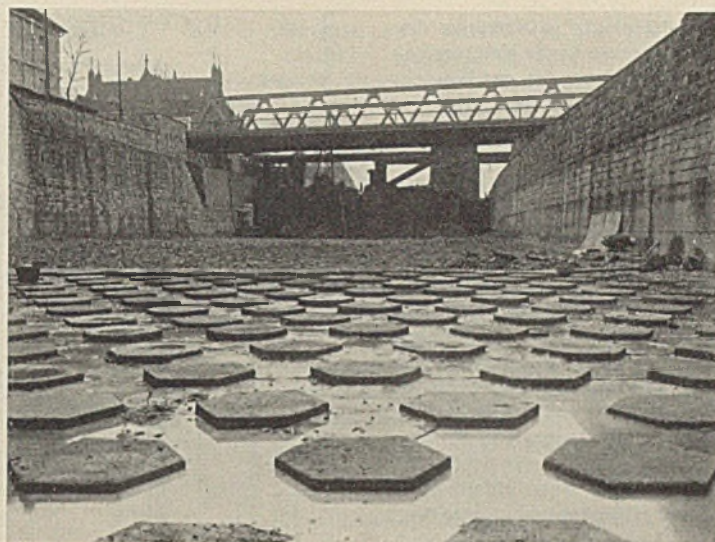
Sturzbettbefestigung mit Betonprismen und Steinschüttung.
